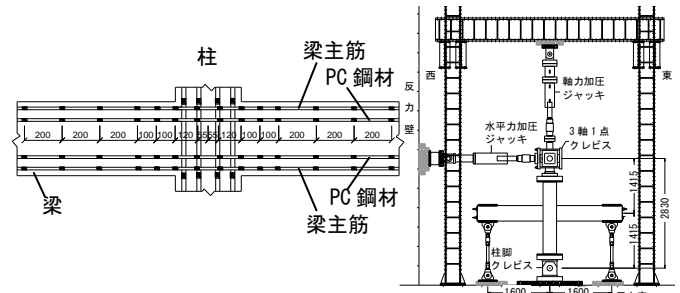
ひずみゲージ貼付位置および加力装置(単位:mm)
